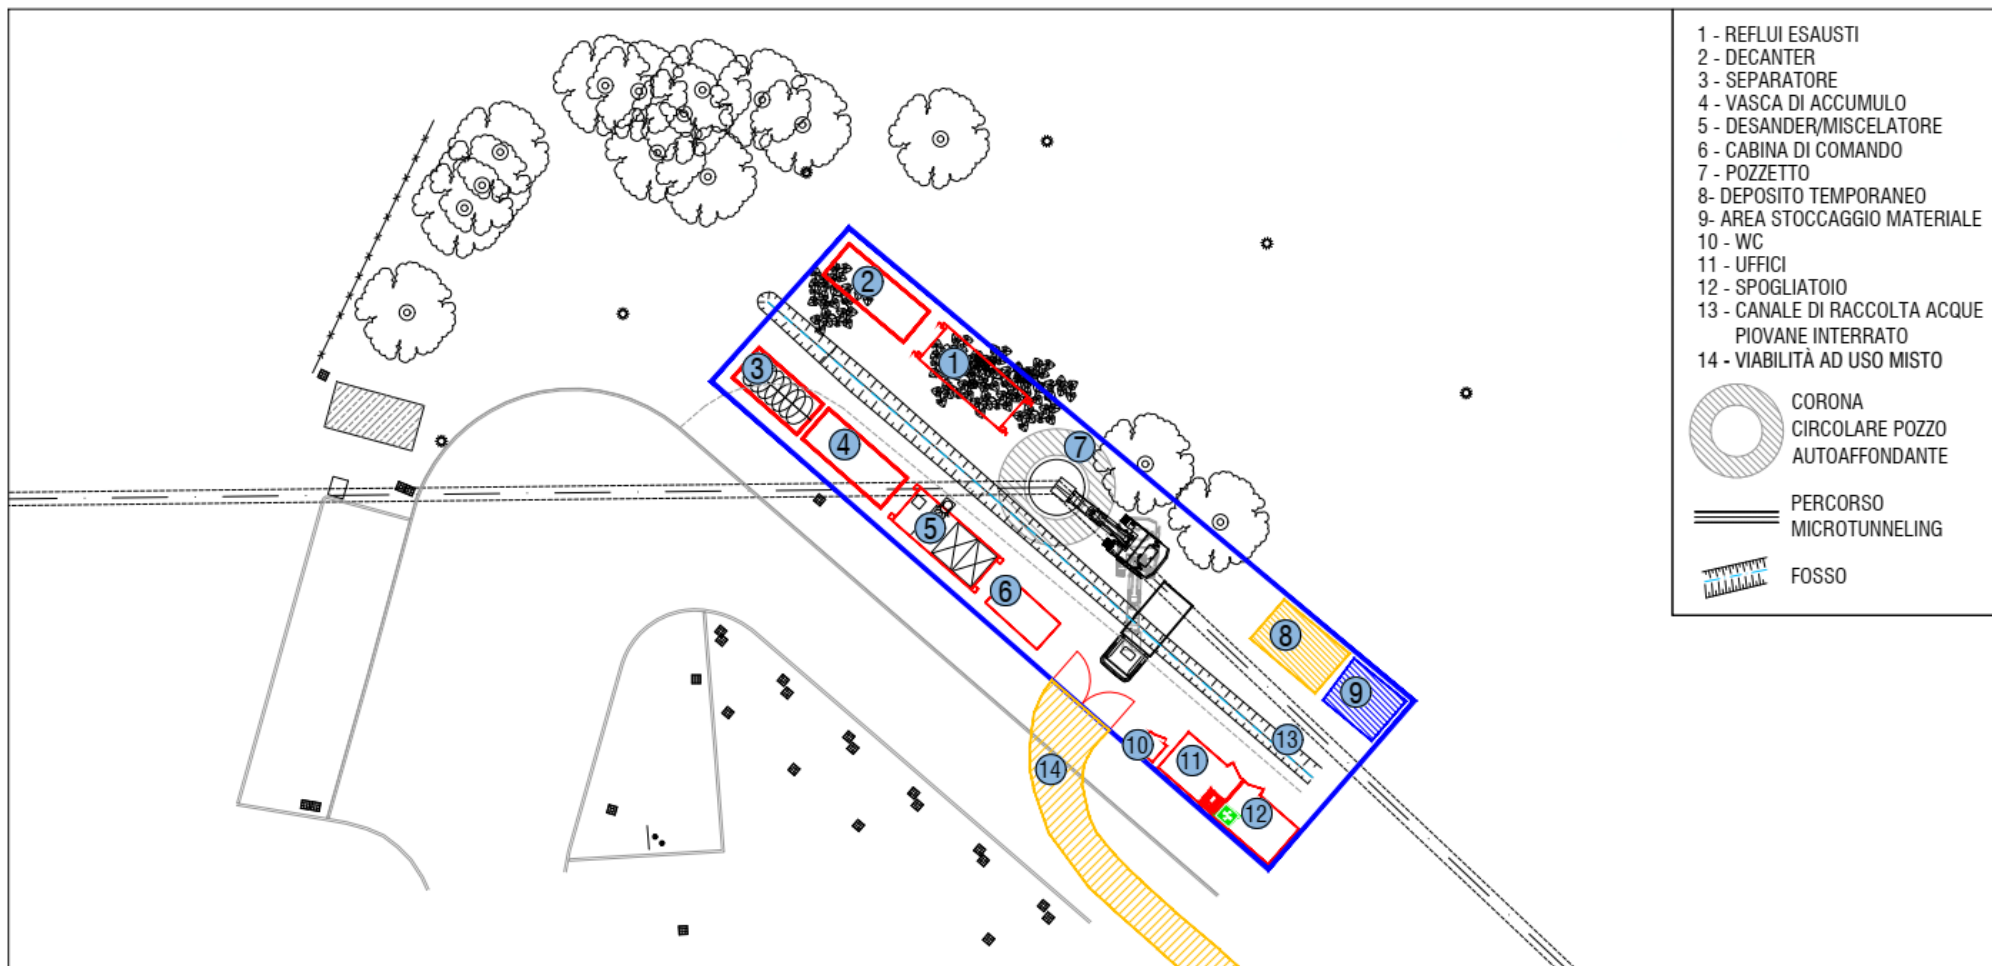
E : Schema cantiere microtunneling pozzo di spinta S2a – DN800
